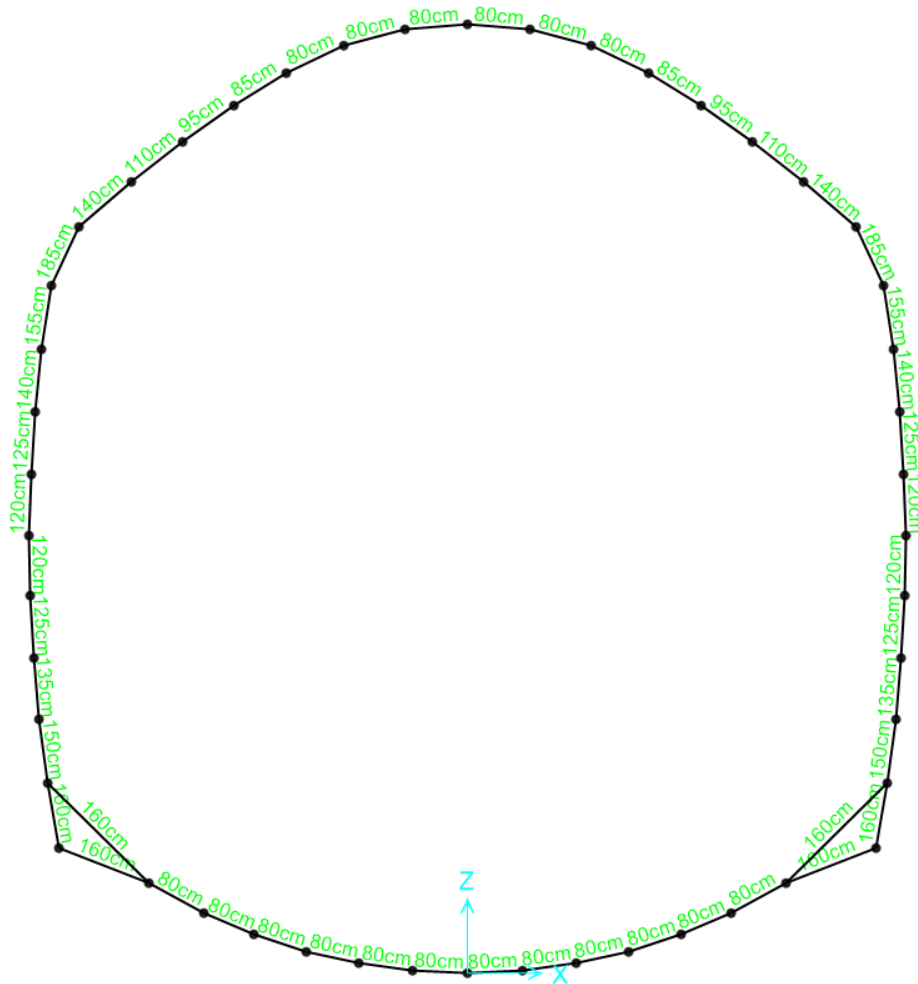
Sezione 1: Schema del modello di calcolo agli elementi finiti: nodi ed elementi frame
